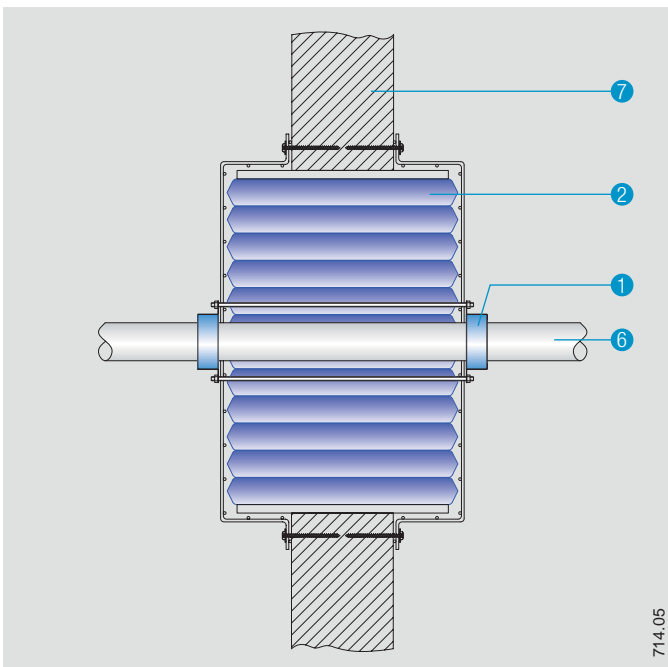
Detail E - Kunststoffrohrabschottung in Massivdeckenkonstruktion
